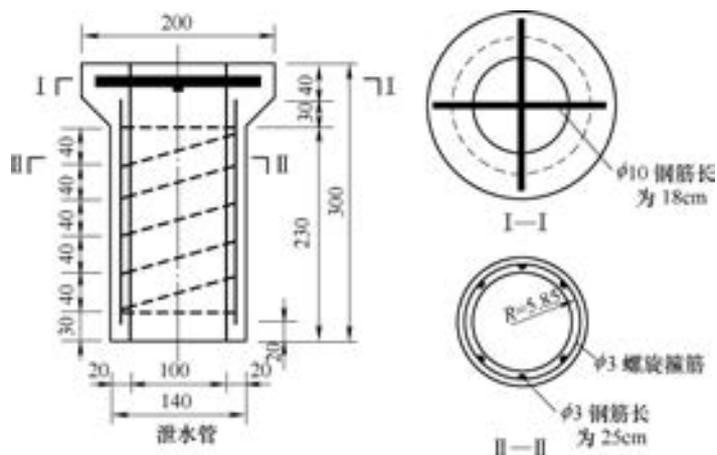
钢筋混凝土泄水管构造 (单位: mm)
